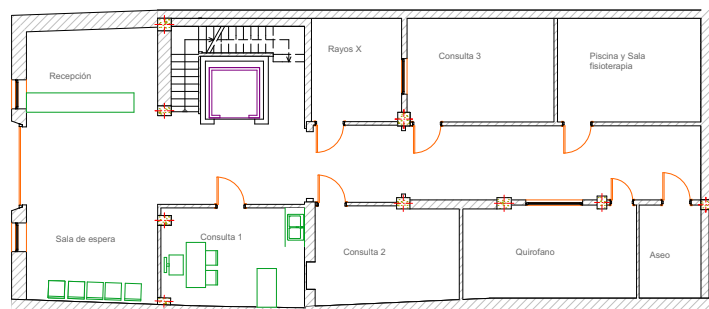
Planta Baja de la vivienda con la distribución inicial.
